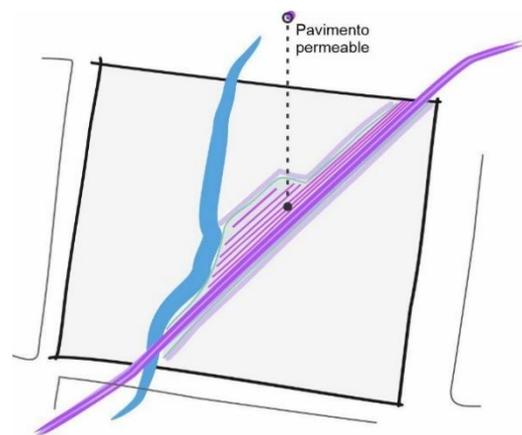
Esquema planta sobre la manzana seleccionada indicando pavimento permeable que acompaña el recorrido de la vía. Elaboración propia.
